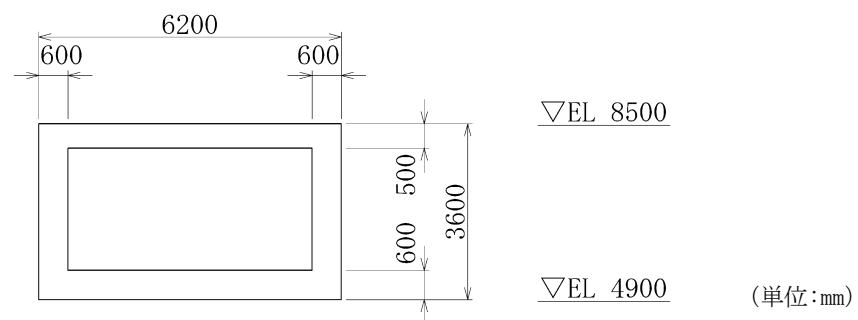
屋外配管ダクト (タービン建物～排気筒) 断面図 (D-D断面)
